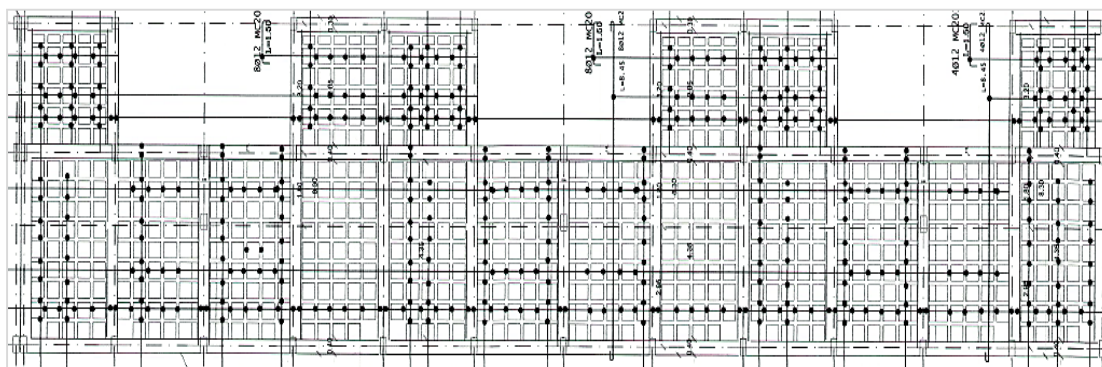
Vista en planta de losa alivianada de cubierta. Casa C41-P9
